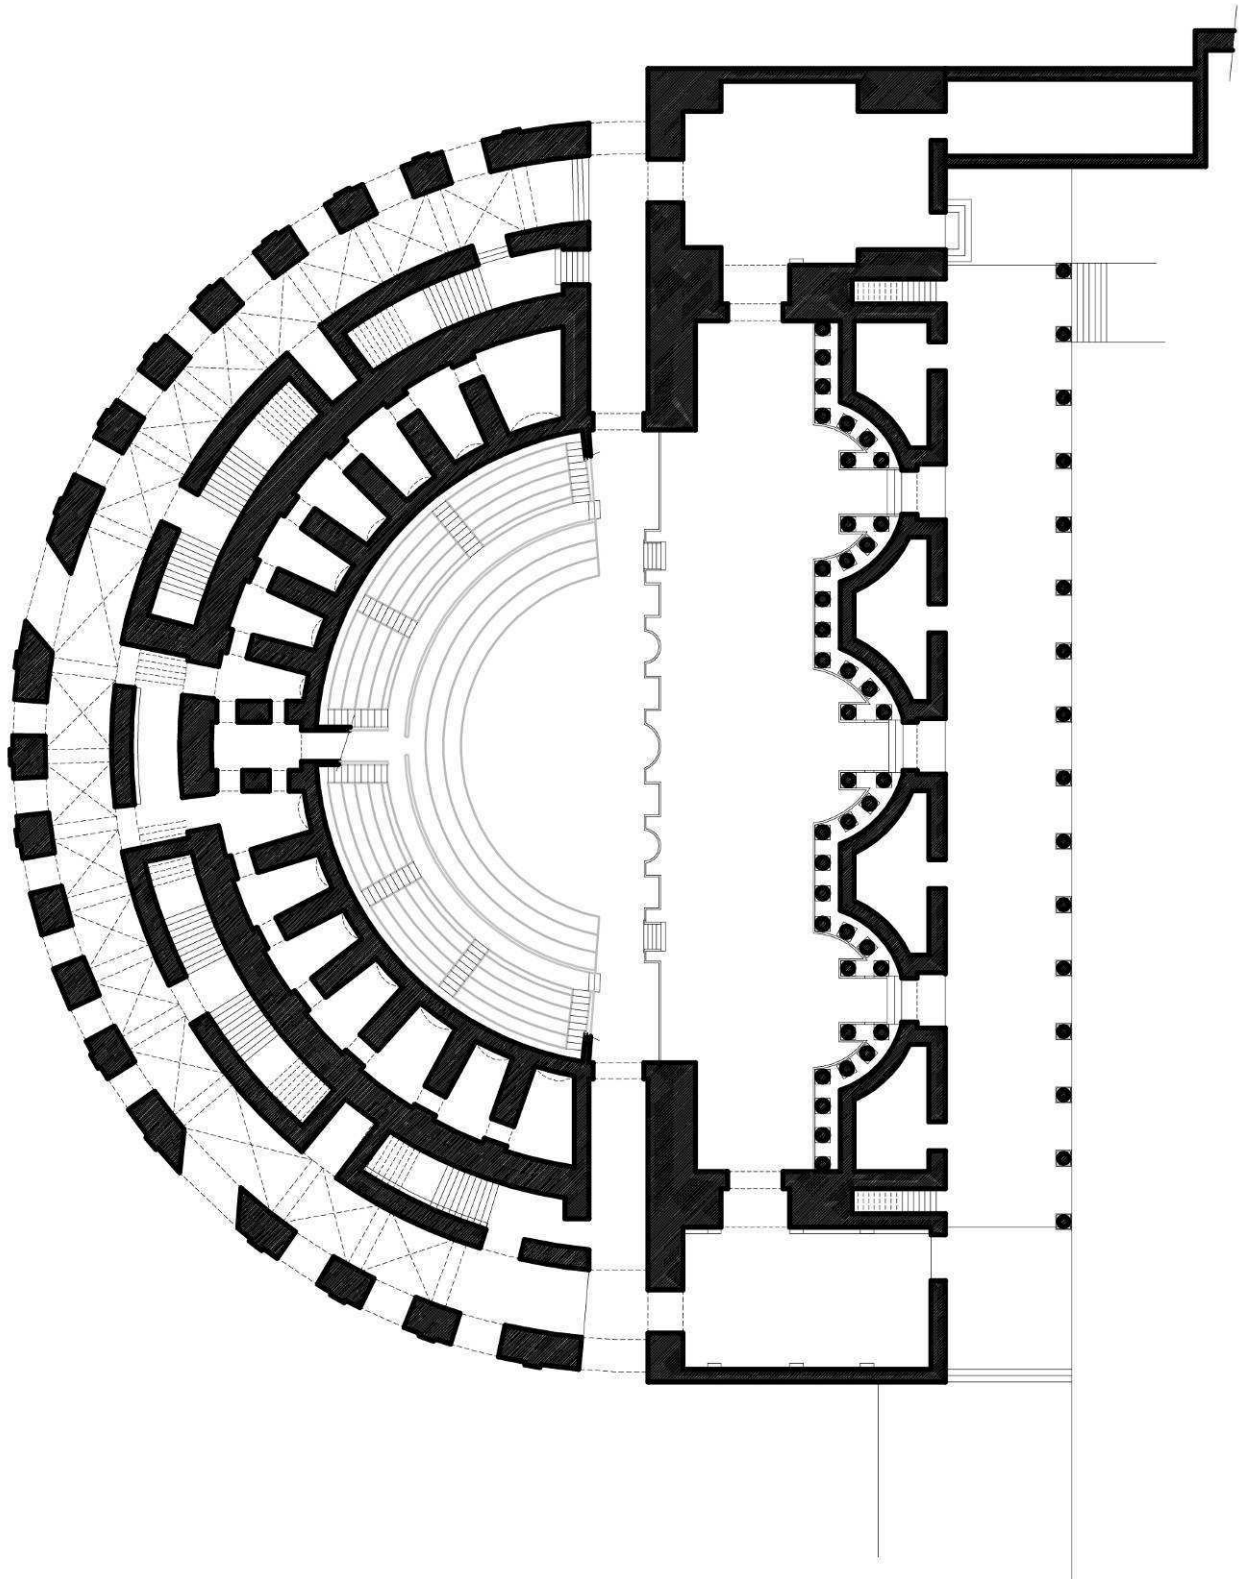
Restitution du théâtre : plan du niveau inférieur des substructions
